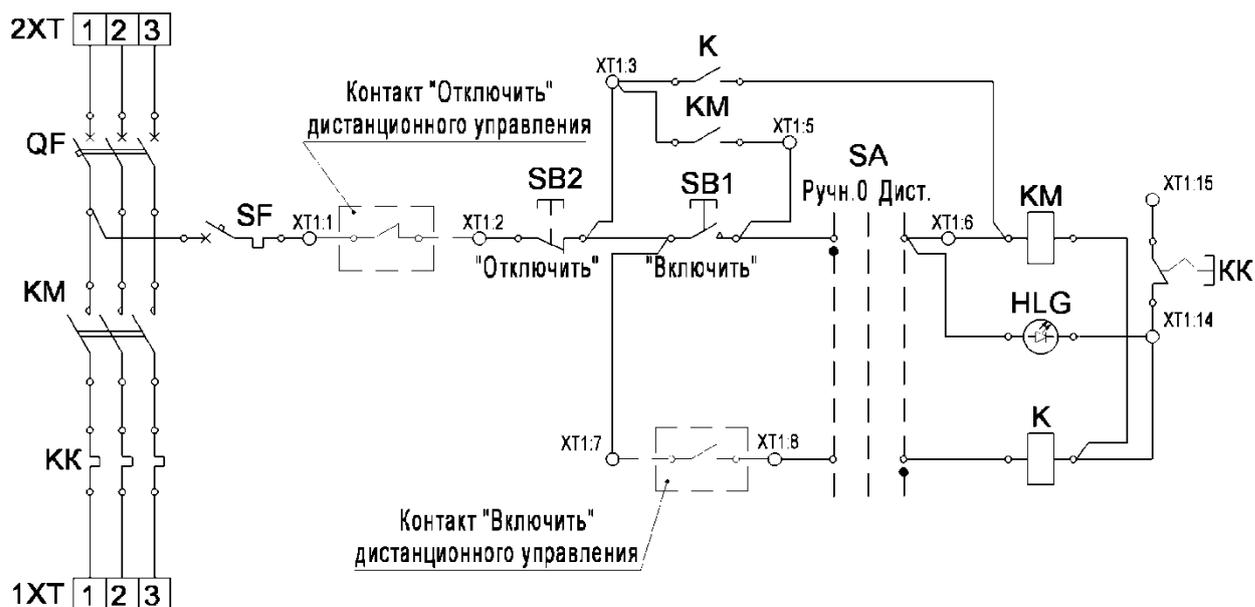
Блок управления двигателем нереверсивный с реле тепловой защиты.
